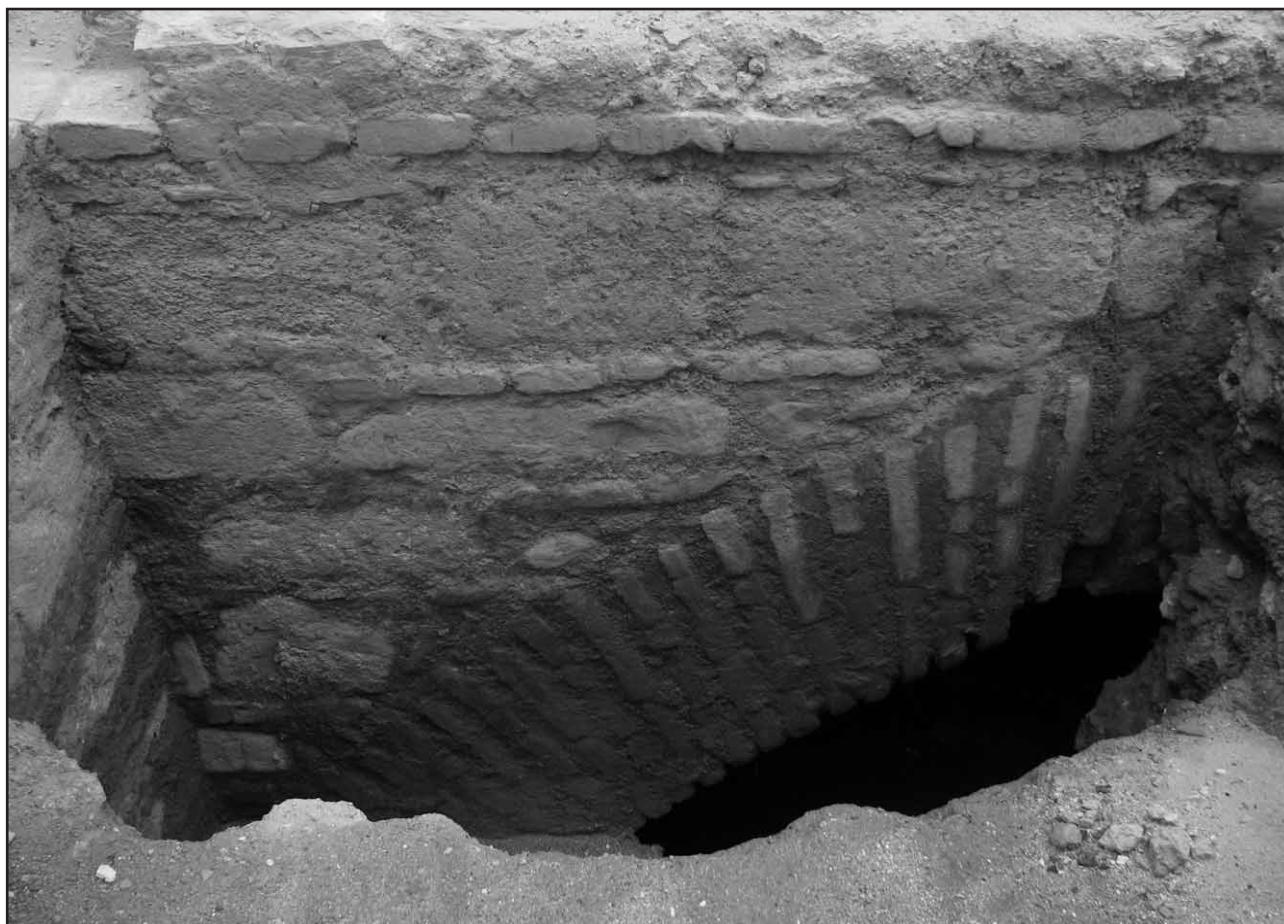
Vista del arco oriental del aljibe construido en la Fase V. Obsérvese la técnica constructiva del muro soporte, con sillares y encintado de ladrillo. Foto: autor
